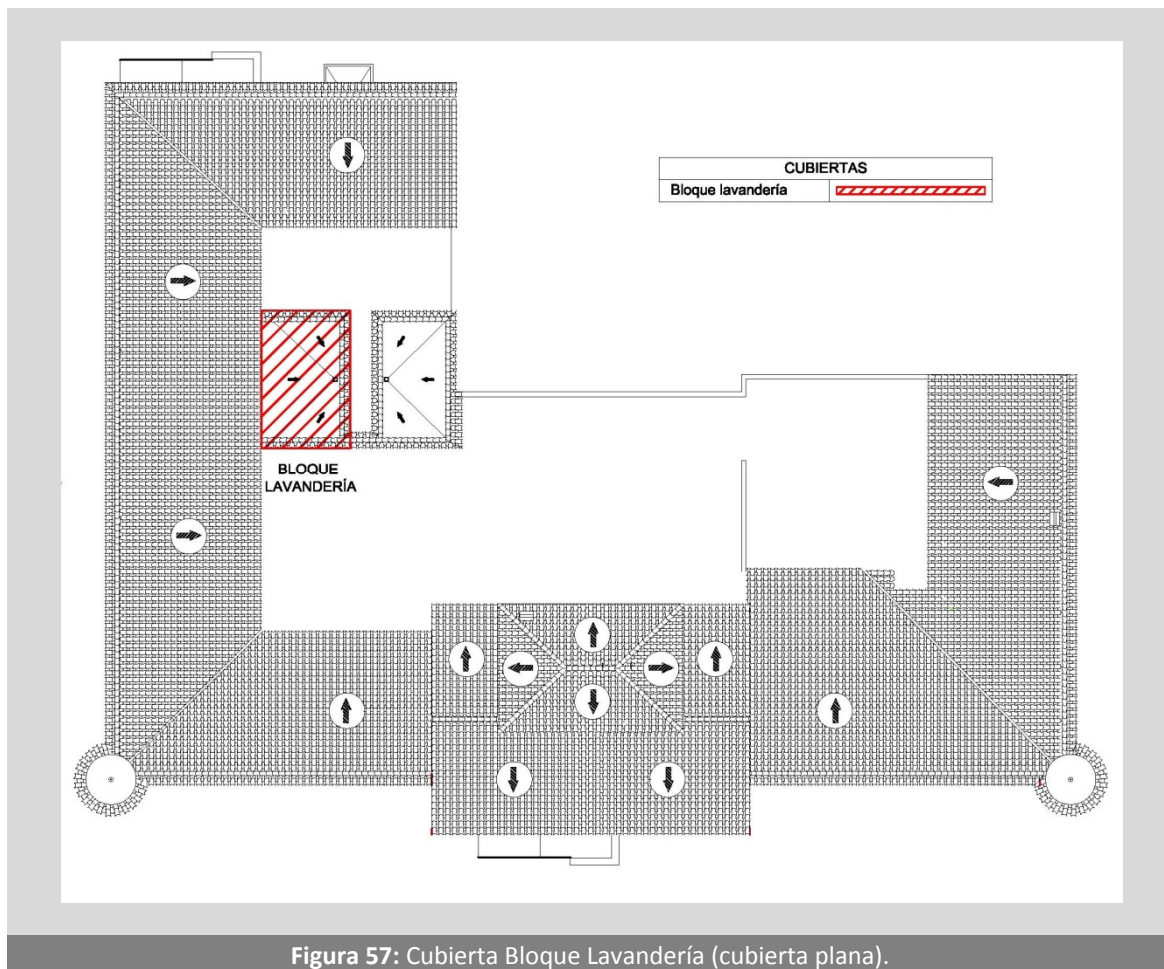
Cubierta Bloque Lavandería (cubierta plana).
